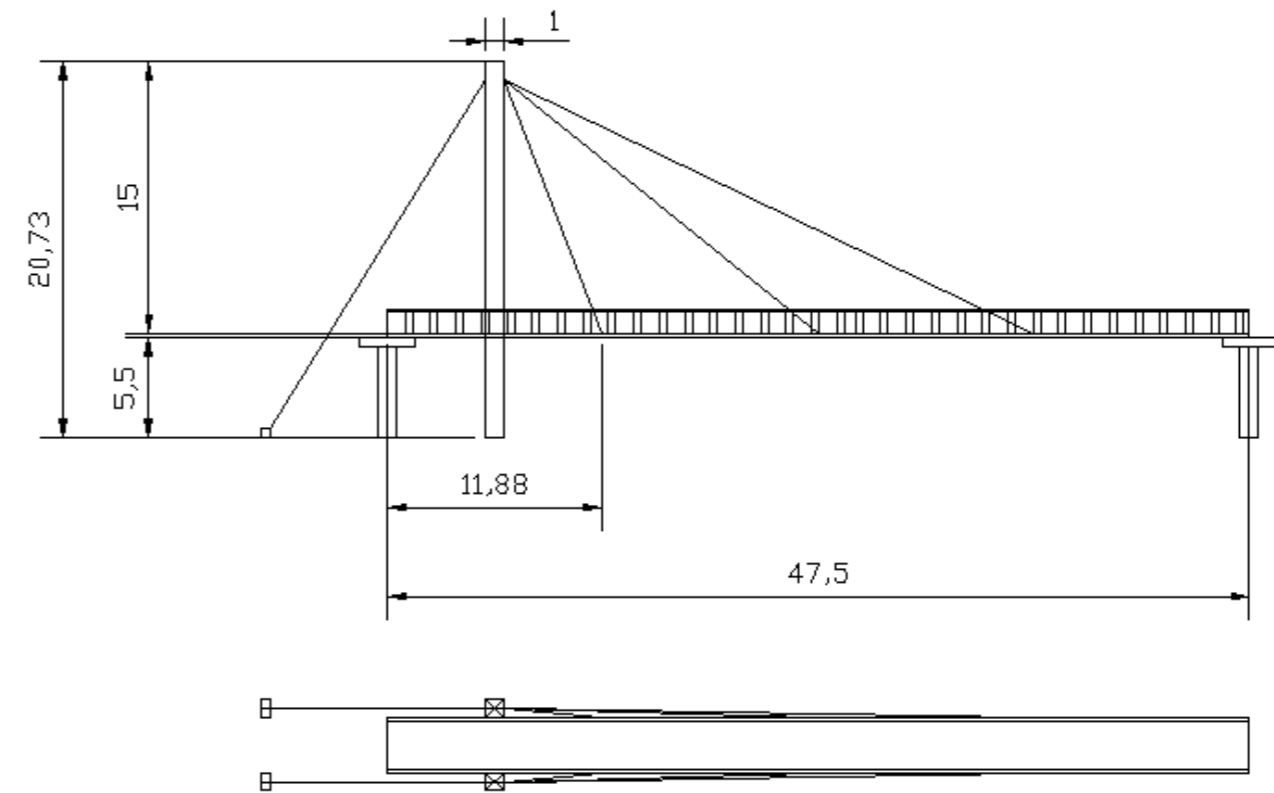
Alzado y planta pasarela peatonal atirantada.
